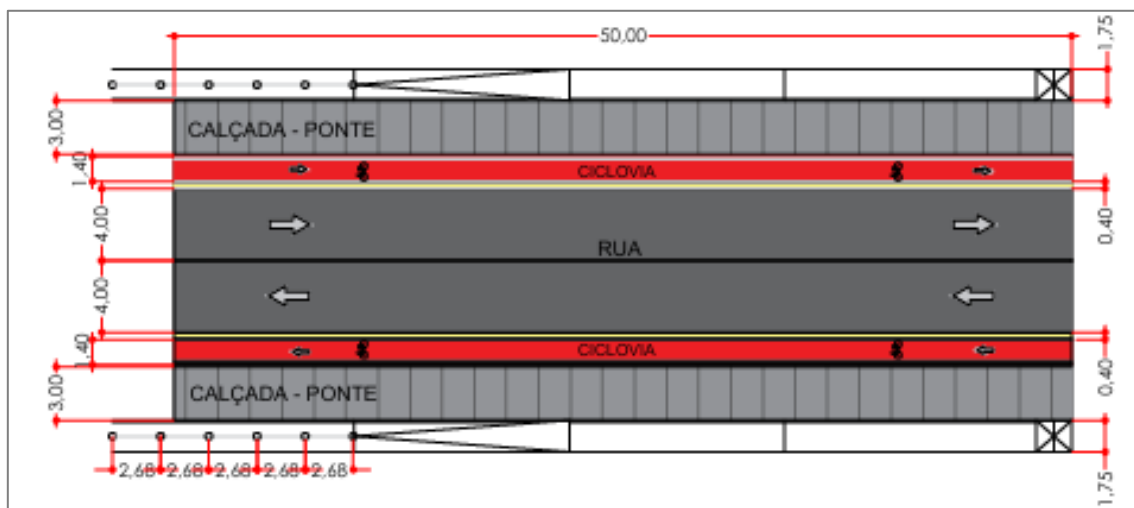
Planta baixa da ponte. Fonte: Projeto elaborado pela Creator.
